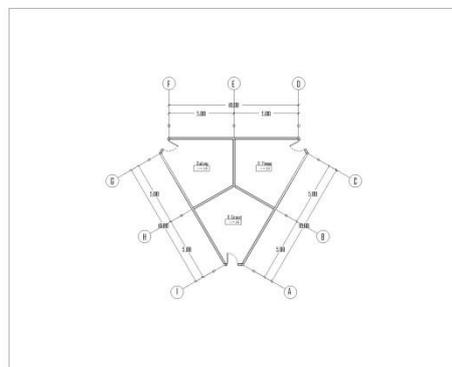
Denah Lantai 2 Ged. C (Kantor Pengelola)
